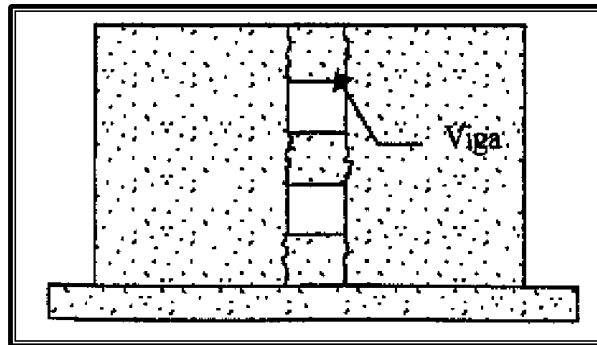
Grietas verticales en los extremos de las vigas de unión en las dos porciones del muro (Falla por corte deslizante)
